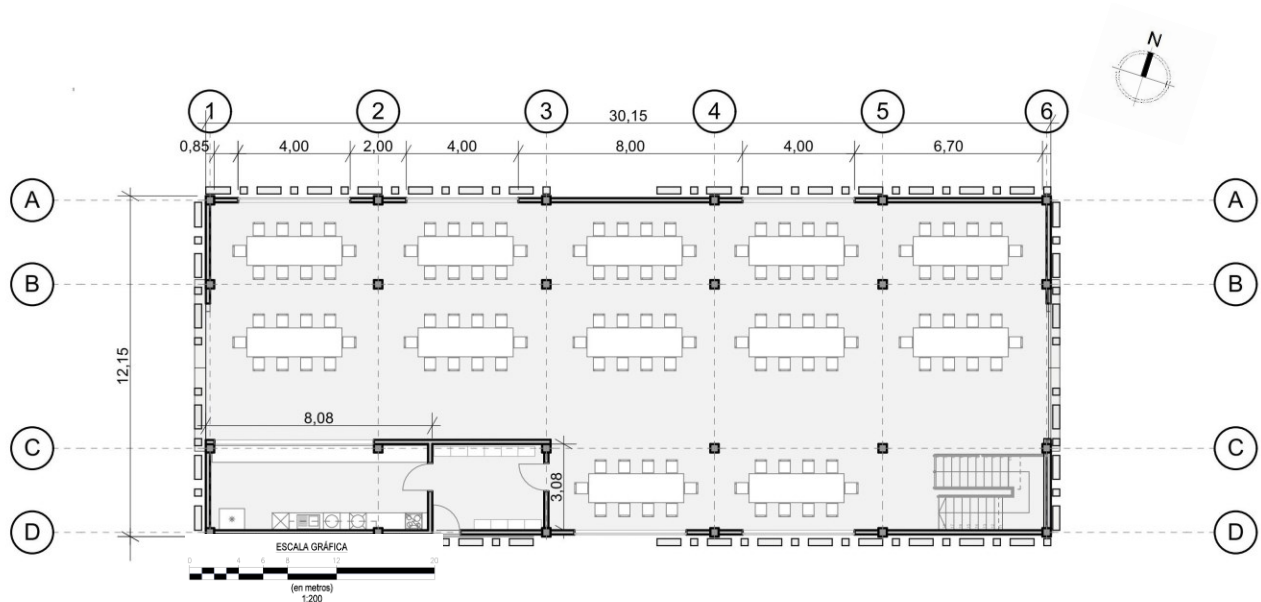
Planta primer nivel bloque B / Fuente: Propia
